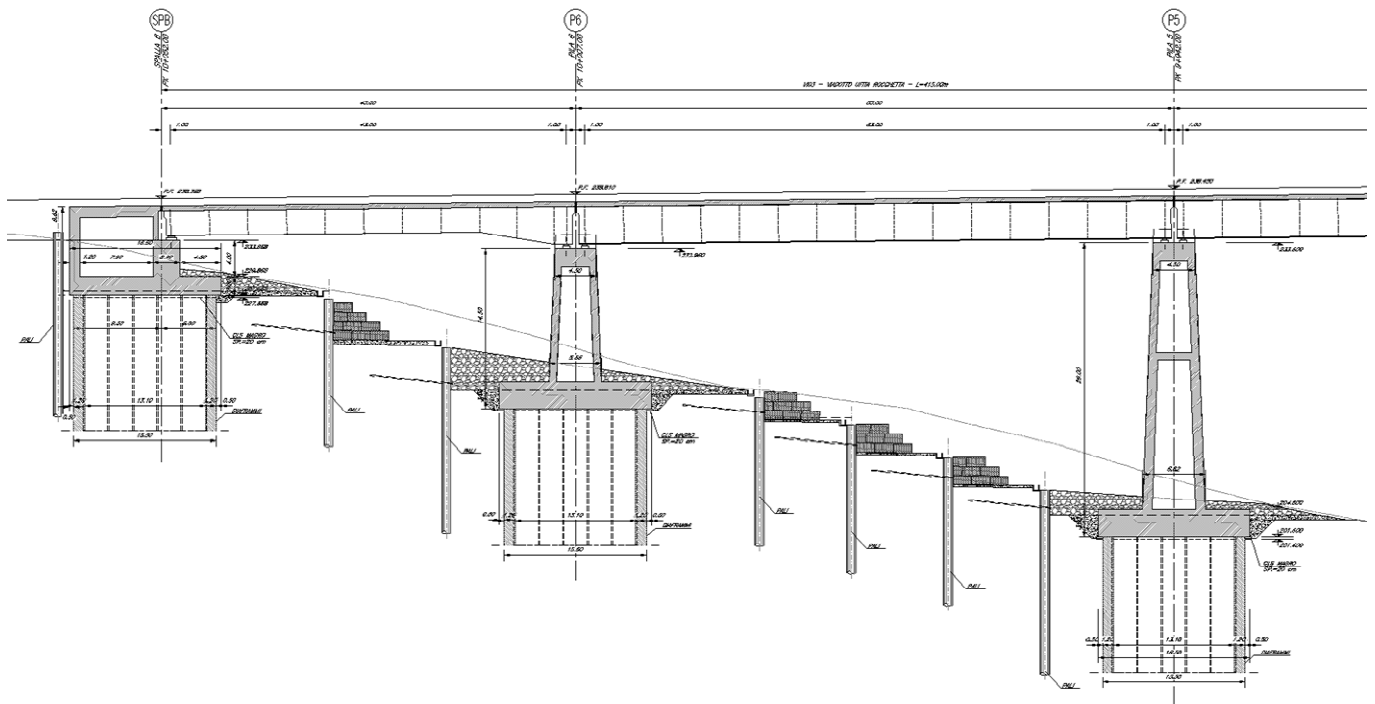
Viadotto VI03. Pila 5: profilo viadotto VI03 e interventi di stabilizzazione del versante in frana
